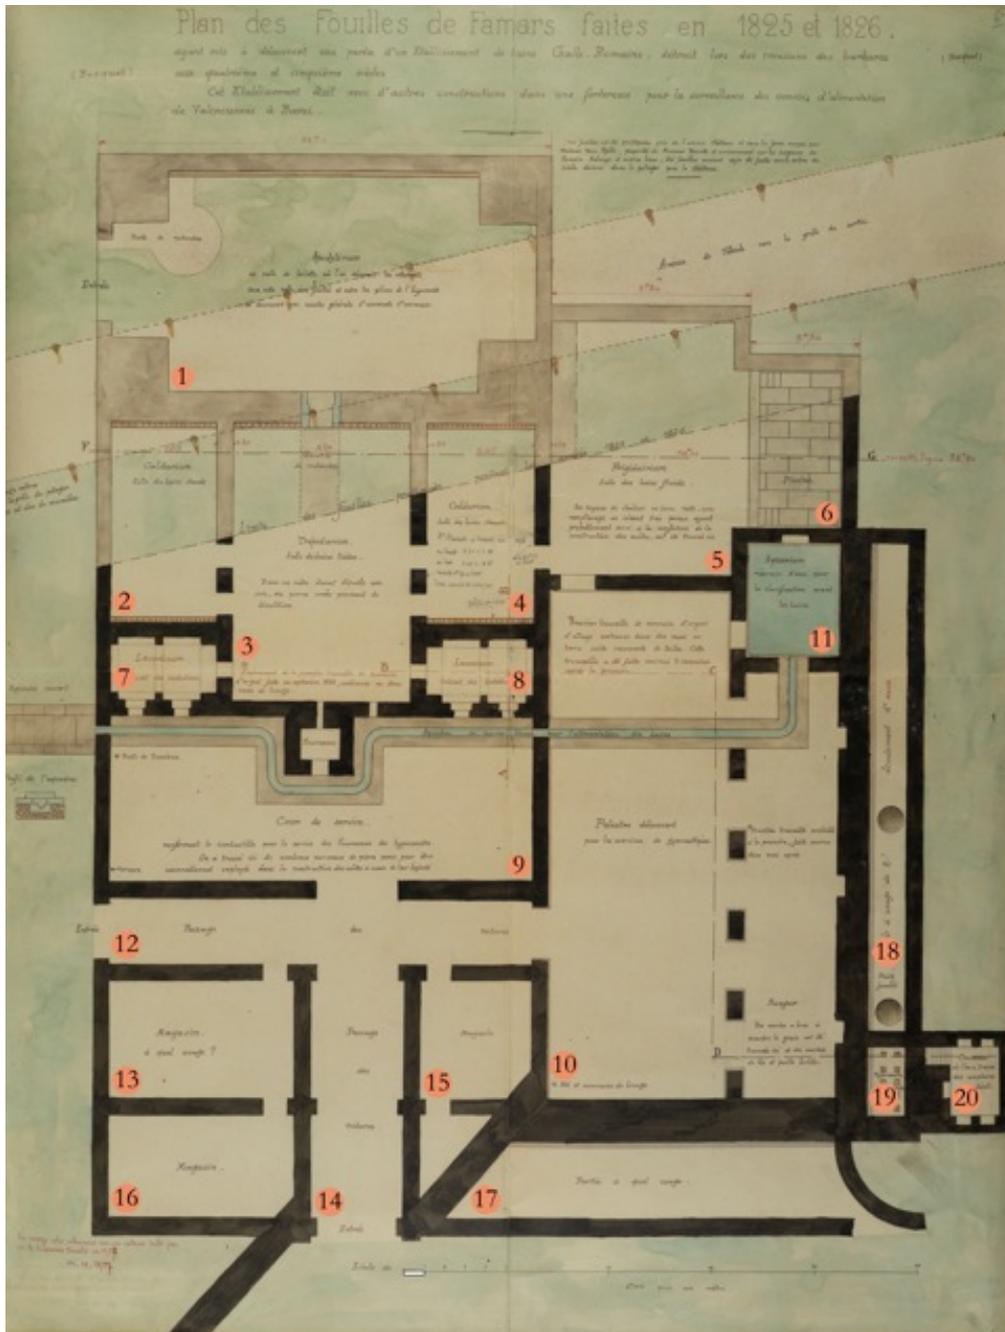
Plan des thermes d'après les fouilles de 1826 par E. Peinte.
